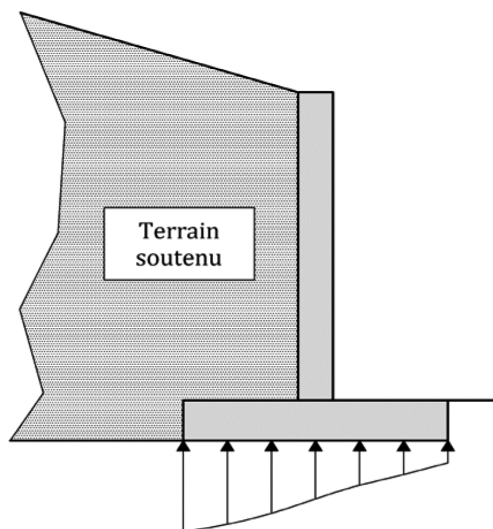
Exemple de contraintes à la base d'un mur en béton armé en forme de T renversé dans le cas d'un sol compressible
